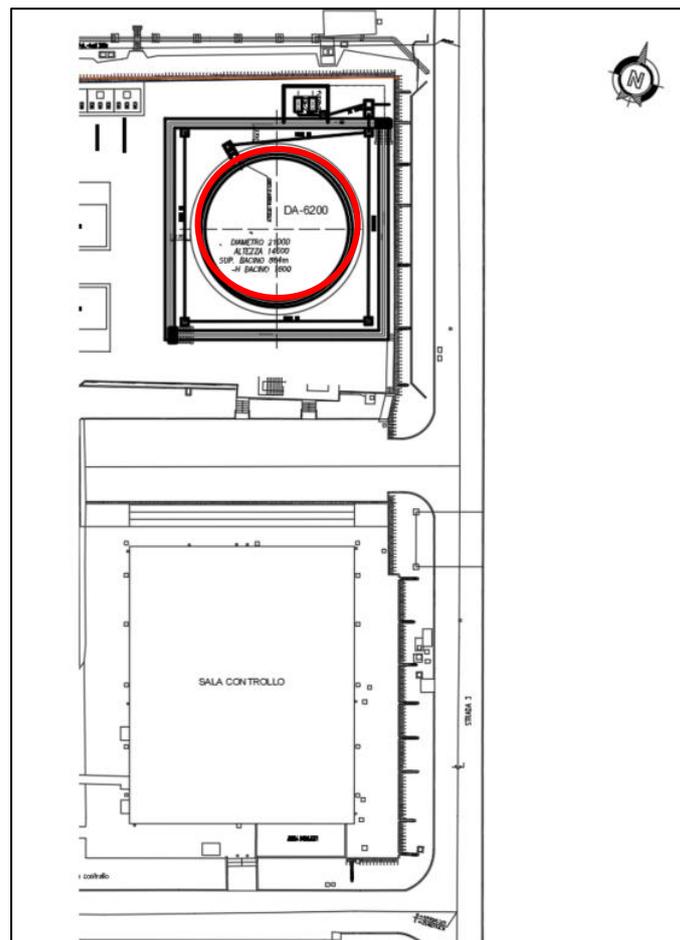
Posizionamento planimetrico nuovo serbatoio stoccaggio acque reflue presso zona nord degli impianti Aromatici
